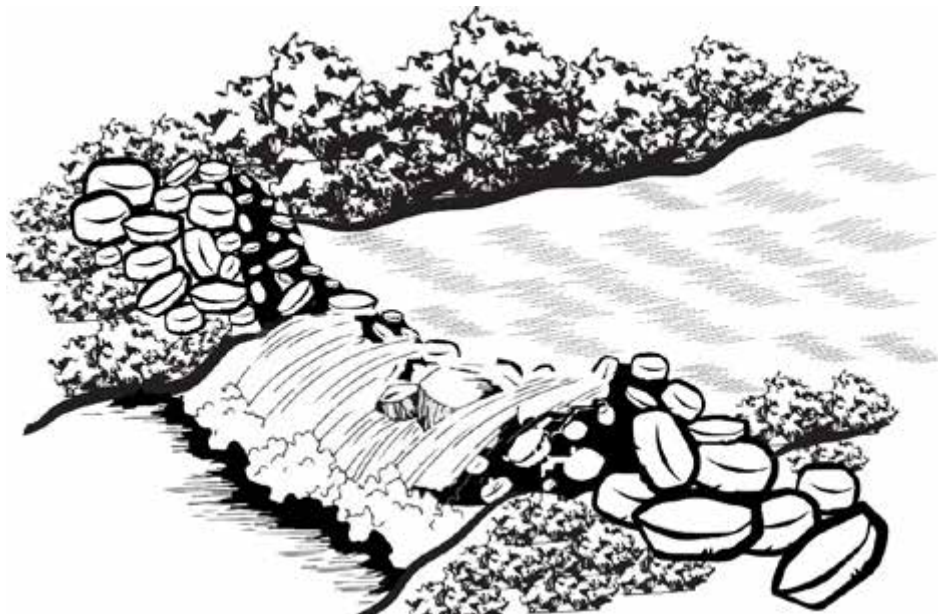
Un barrage en remblai construit à partir de blocs de pierre
